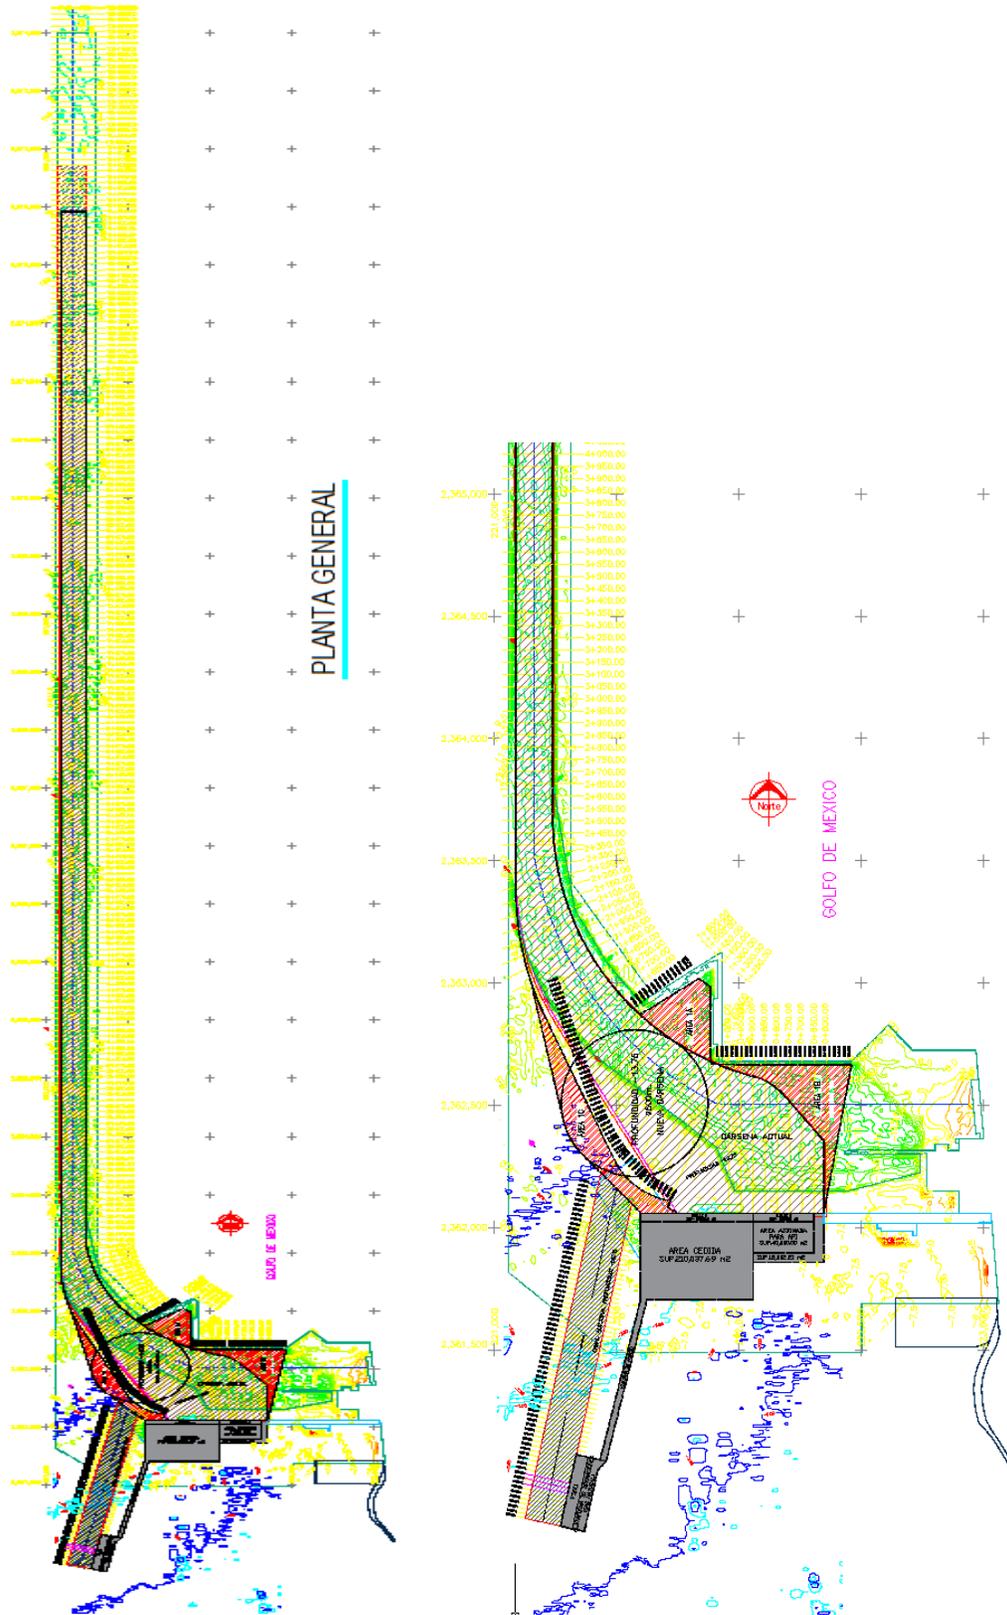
Plano general del proyecto (Detalle de planos en ANEXO 1).
